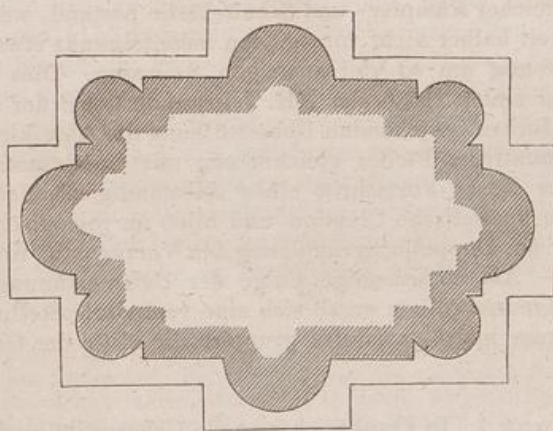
Grundriss eines Hauptpfeilers im Schiffe des Münsters zu Basel (nach Riggenbach).
